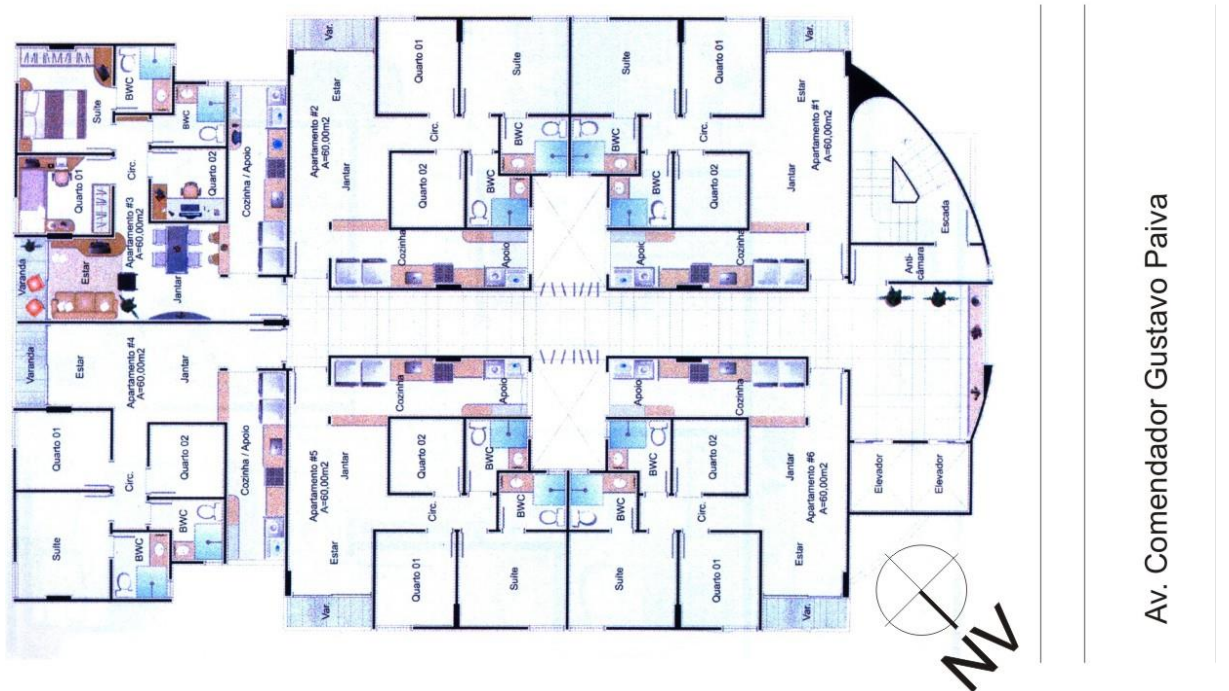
Planta baixa do pavimento tipo do edifício Torre Norte
